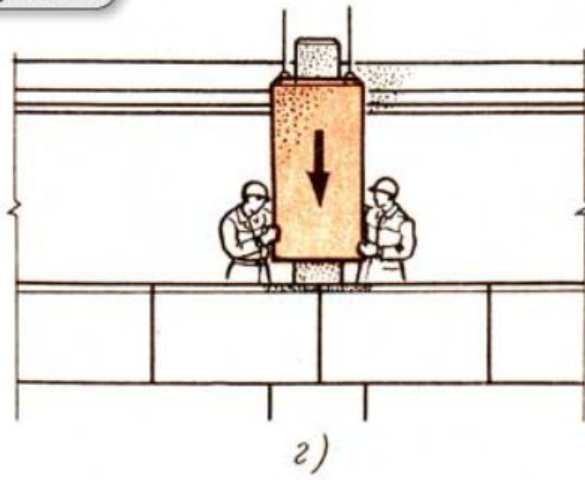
Монтаж наружных панелей в каркасных зданиях
